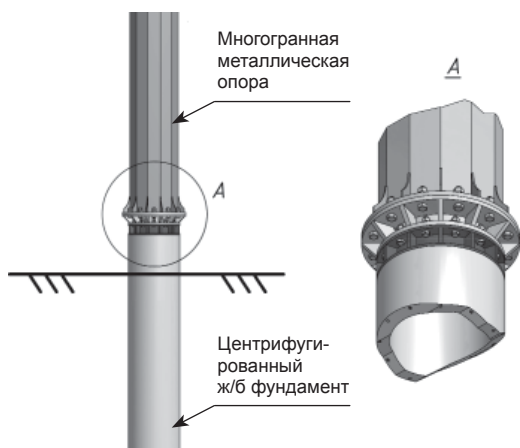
Схема железобетонного фундамента из центрифугированных предварительно напряженных секций диаметром 800 мм, имеющего металлический фланец для соединения с опорой (многогранной или железобетонной)
